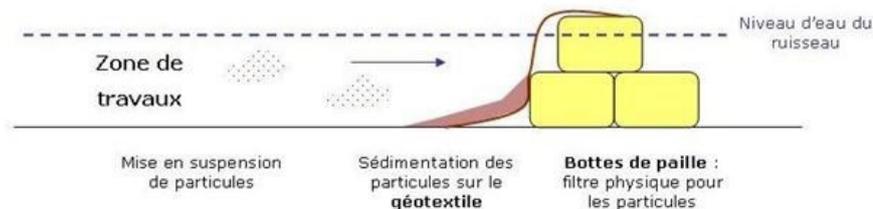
Principe du dispositif de filtrage en aval des travaux avec bâche géotextile et ballots de paille
